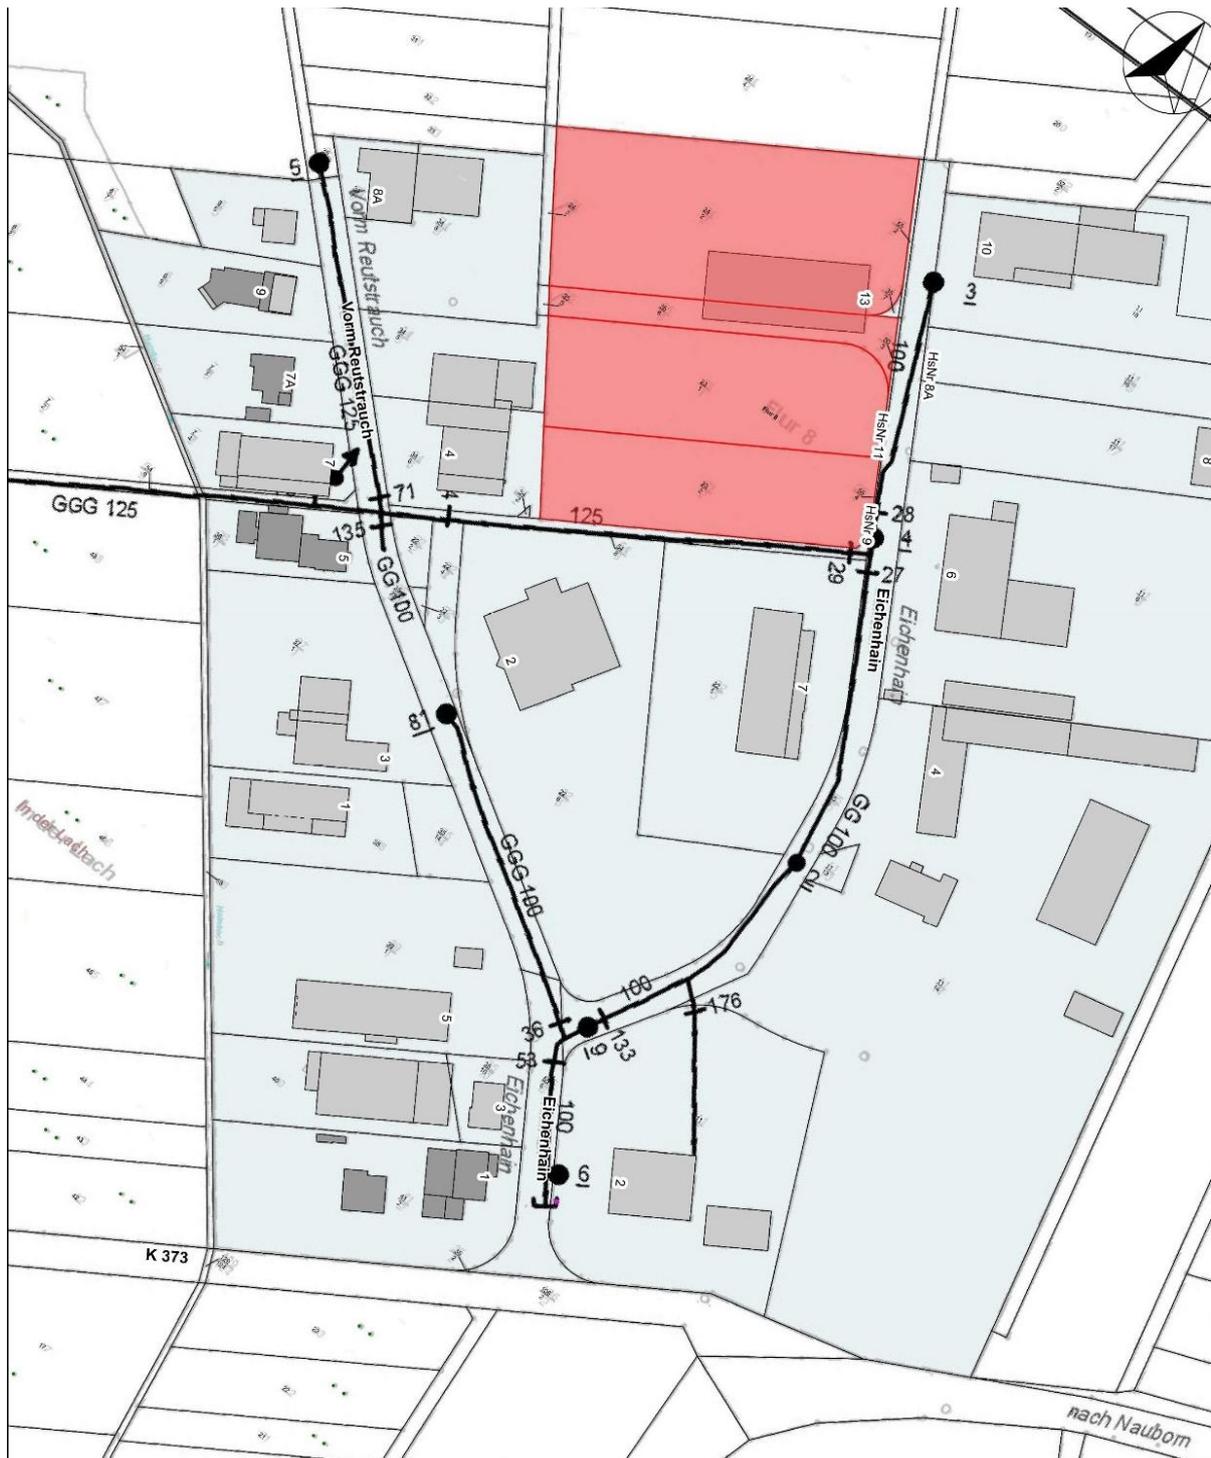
Bestand der Wasserversorgungsleitungen (Quelle Gemeinde Schöffengrund, Stand: Februar 2022)
